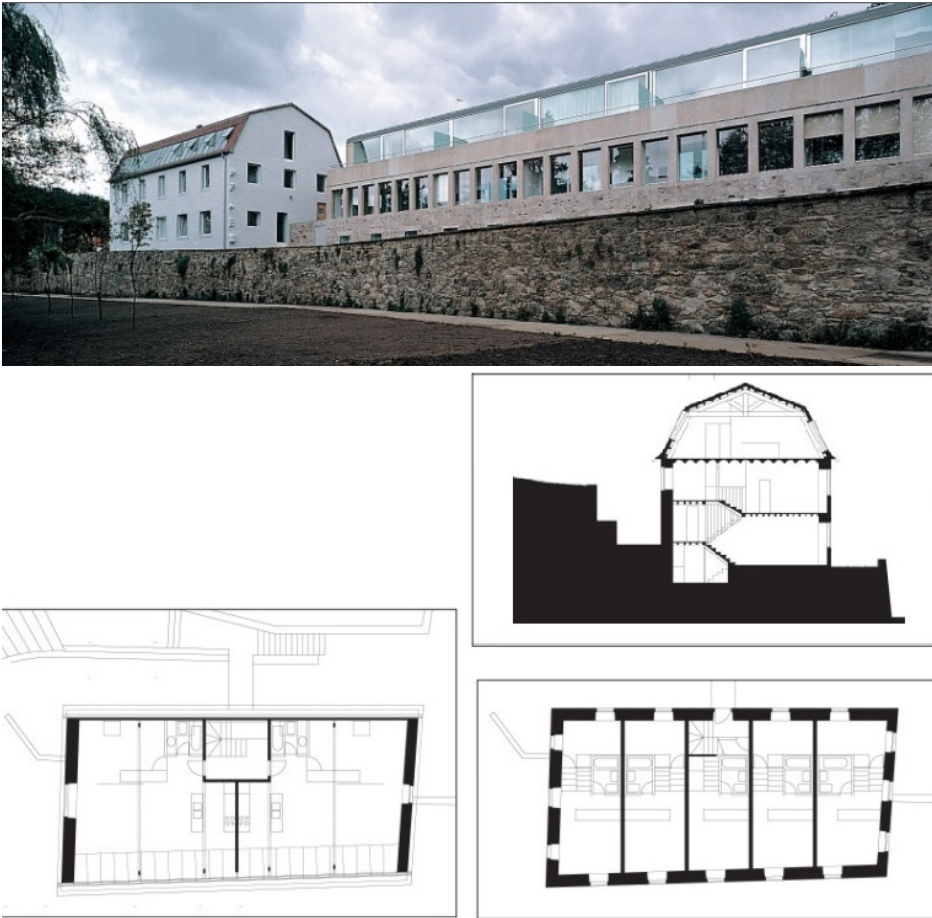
Vista conjunto residencial, plantas y secciones de edificio Vaquería.
